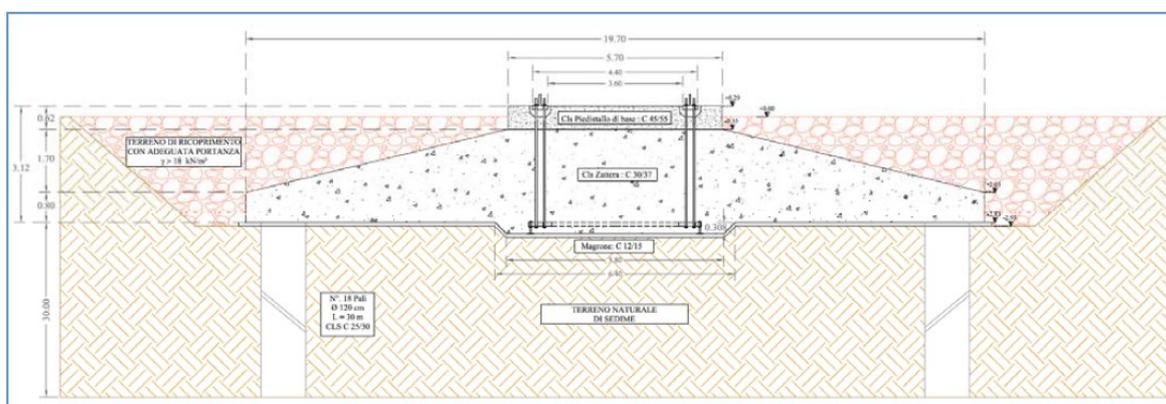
Sezione e Pianta architettonica tipo della fondazione.
